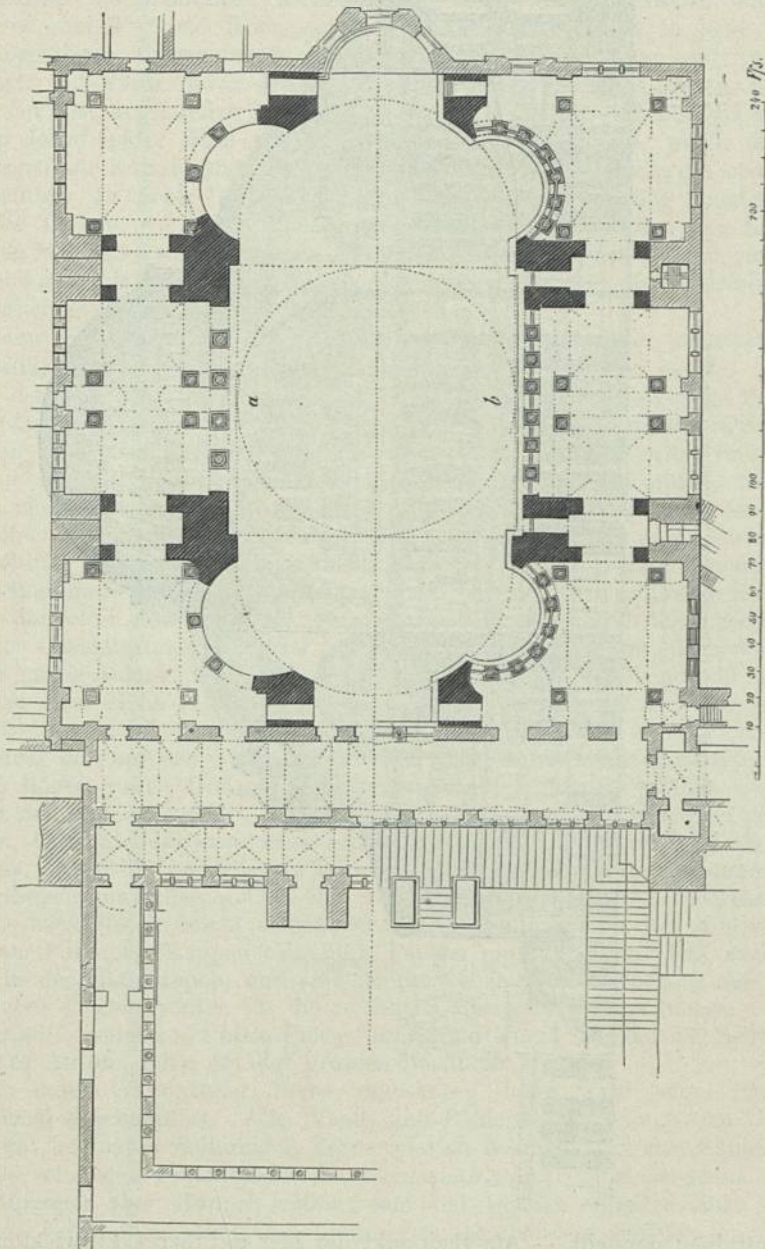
Grundriss (a Erdgeschoss, b Emporen) der Sophienkirche in Konstantinopel
